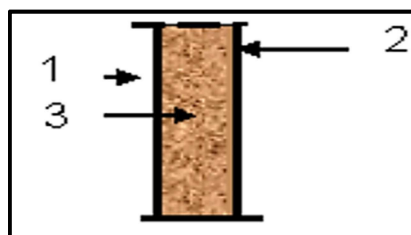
Coupe verticale de la maçonnerie murs intérieurs
